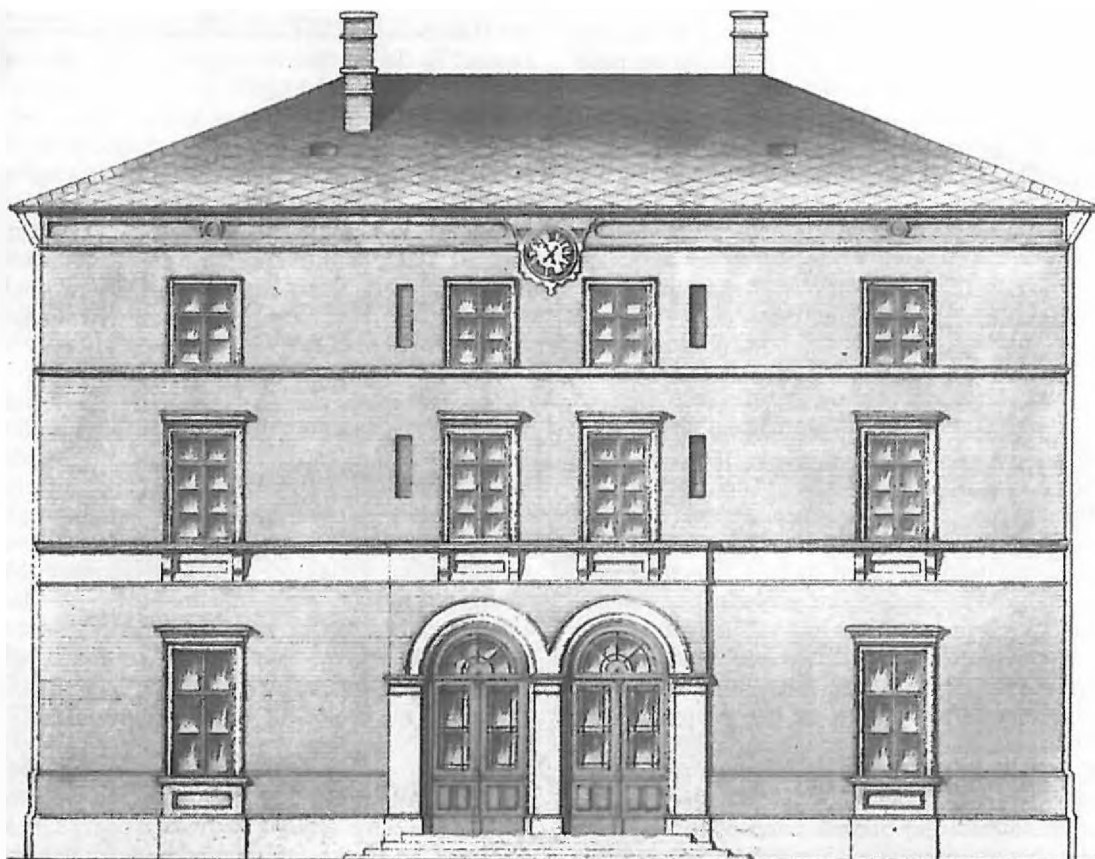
Ansicht des Empfangsgebäudes des Bahnhofs Landsberg von der Straßenseite in einem Plan des Baukatasters der Eisenbahnbausektion Landsberg von 1873; verkleinerter Ausschnitt aus dem handkolorierten Original.
